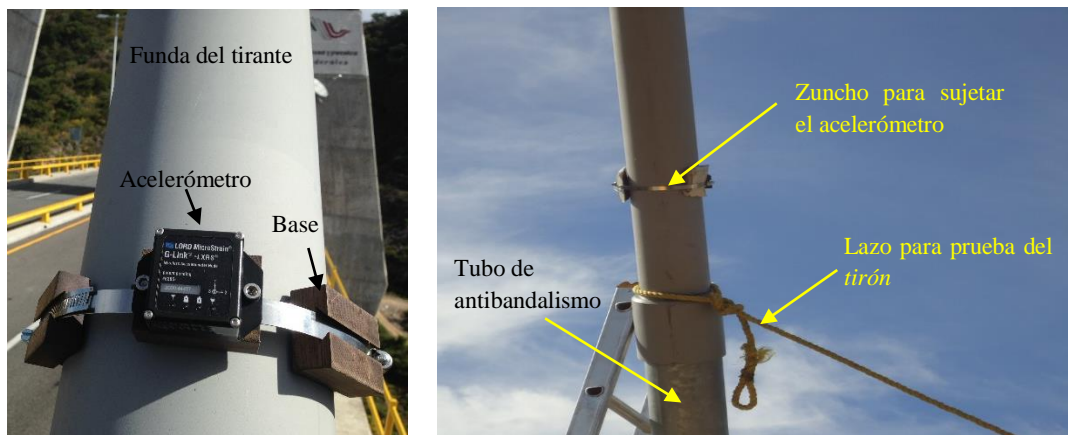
Acercamiento a acelerómetro instalado y sujeto con sistema mecánico: (a) vista superior; (b) vista inferior
